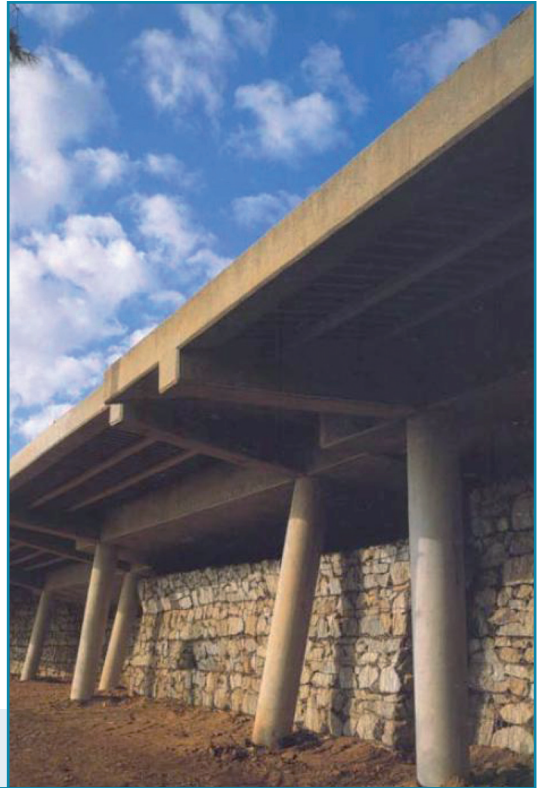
Cubiertas con fuste de hormigón inclinadas sustentado las paredes y las cubiertas.
